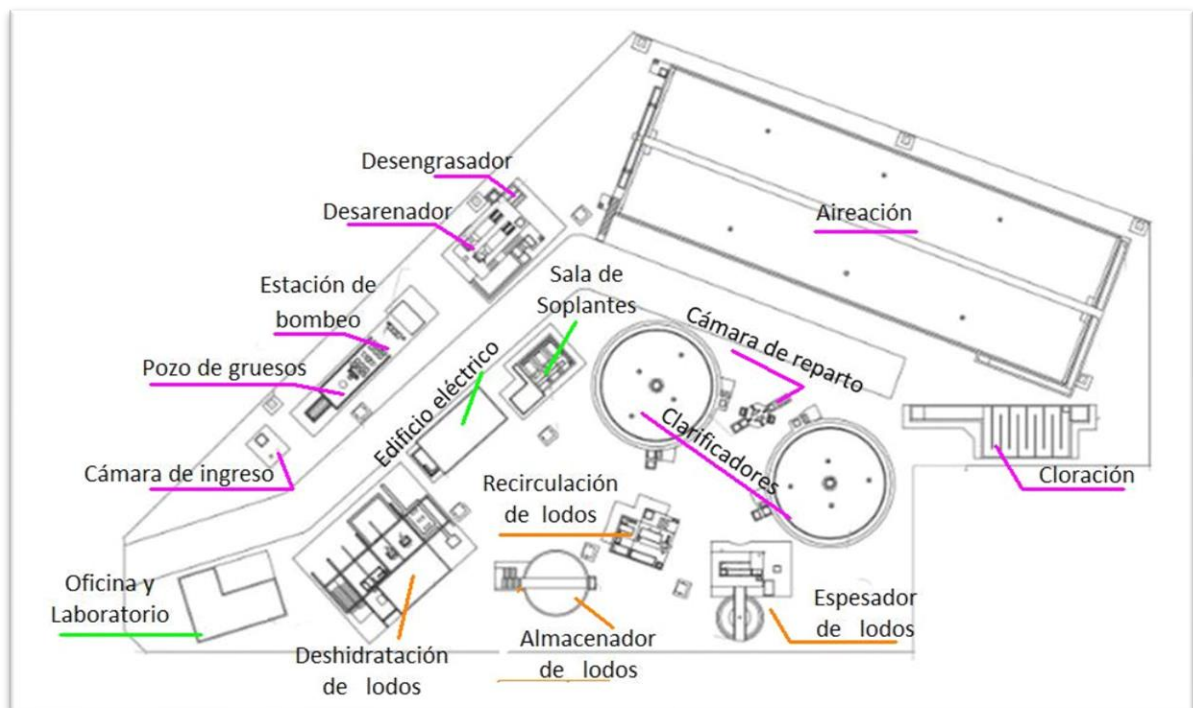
Plano de la planta de tratamiento. Fuente OPISU.
